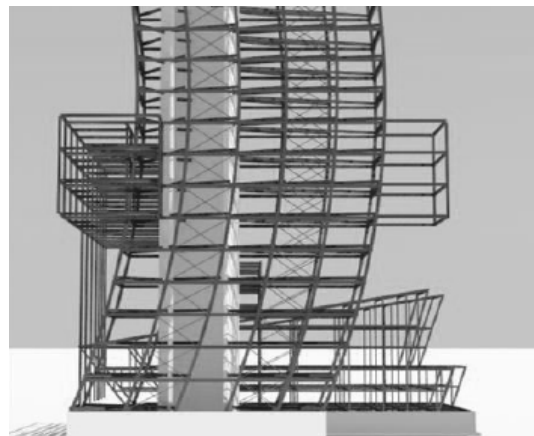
la structure en nyau central source : [www.detailconstructif.cype.com](http://www.detailconstructif.cype.com)
